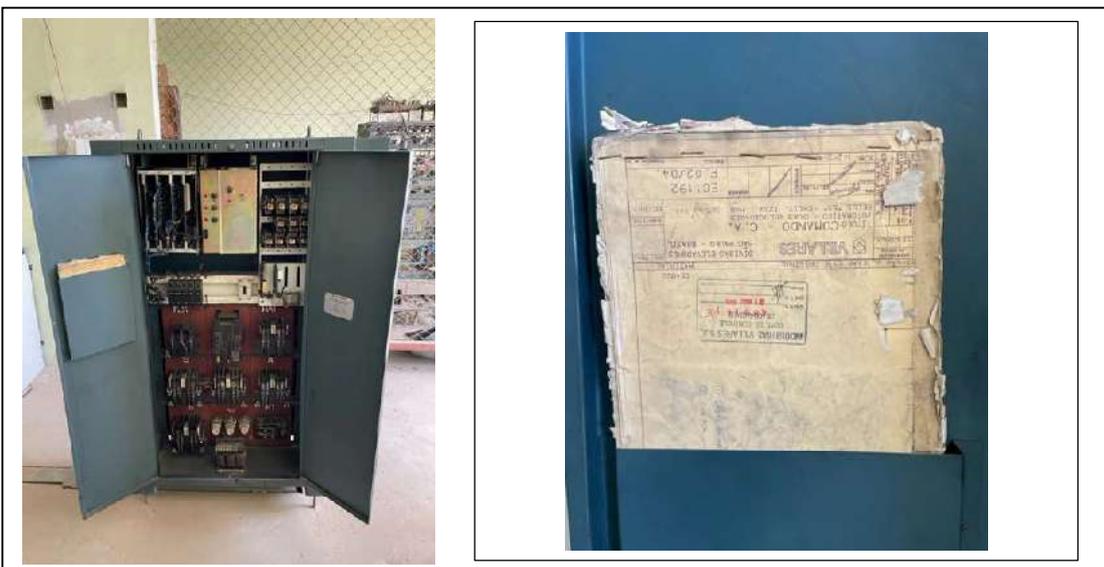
Comando do elevador principal – detalhe de projeto de execução existente
